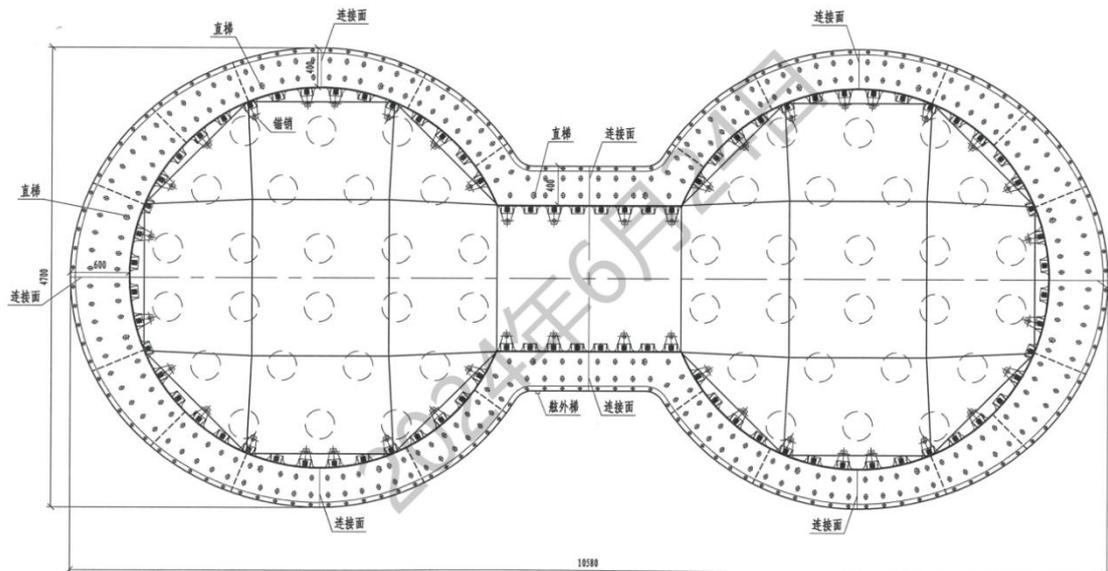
防撞套箱总体布置平面图 (单位: cm)
